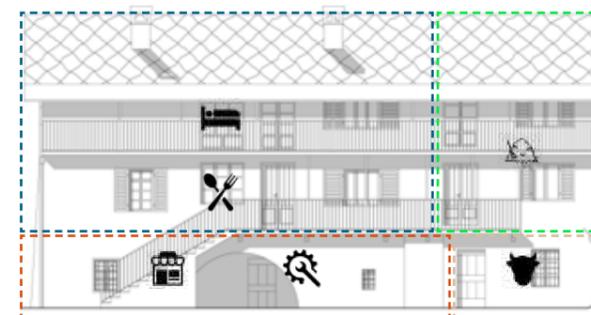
Prospetto Sud, edificio n.8 Fuori scala, in figura vengono rappresentate le ipotesi di disposizione dei vani
